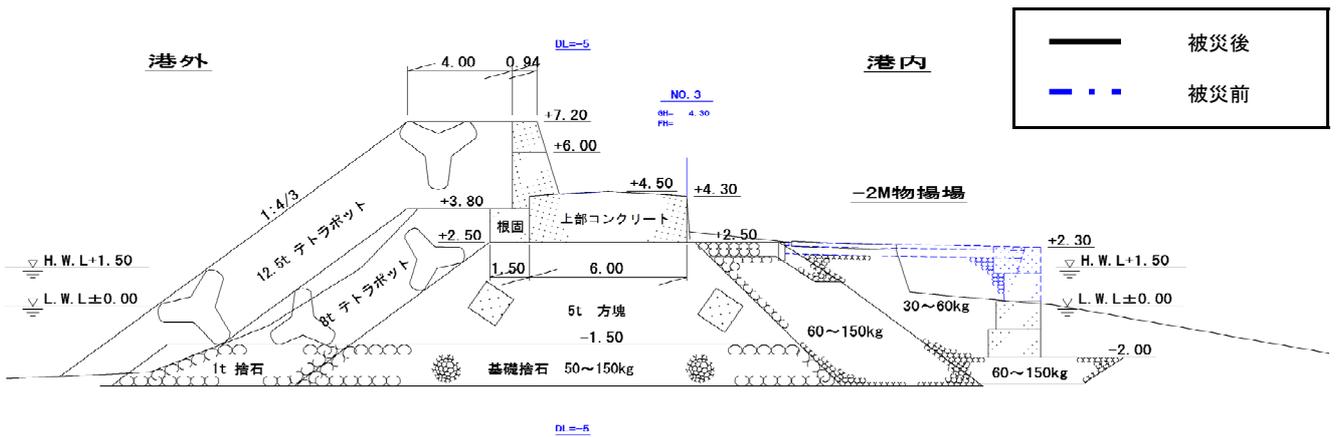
No.25 大洗港区_第1埠頭地区B物揚場 (-2m) の断面図 (被災後)
